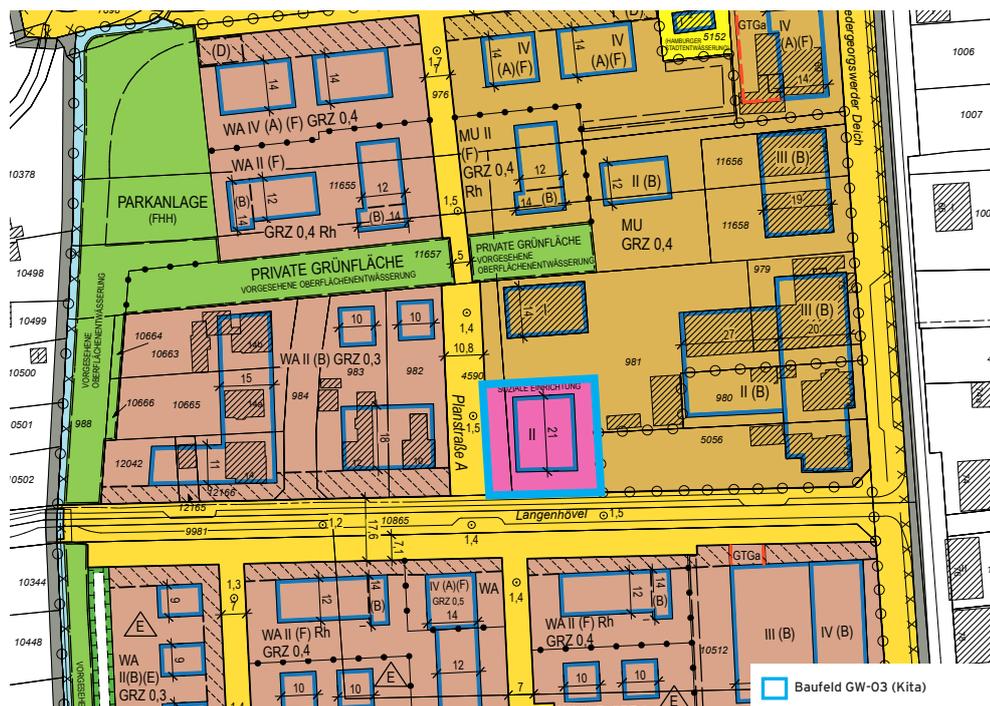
| Planungsrecht: Bebauungsplan Wilhelmsburg 97
